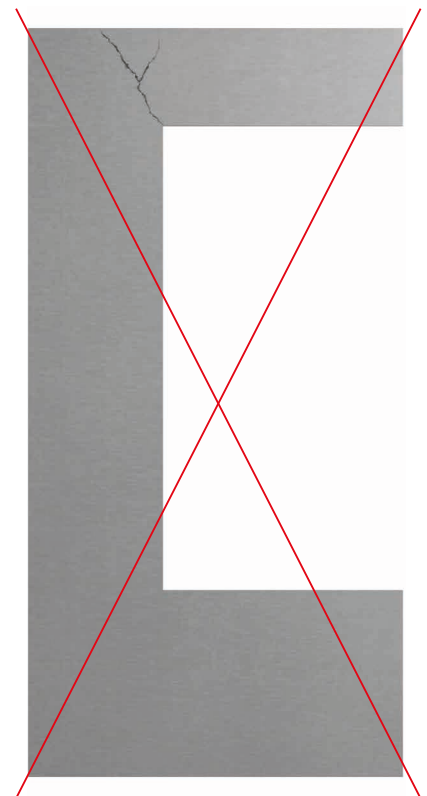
Installation incorrecte de Swisspearl panneaux de façade au niveau des fenêtres, des portes et des ouvertures.
